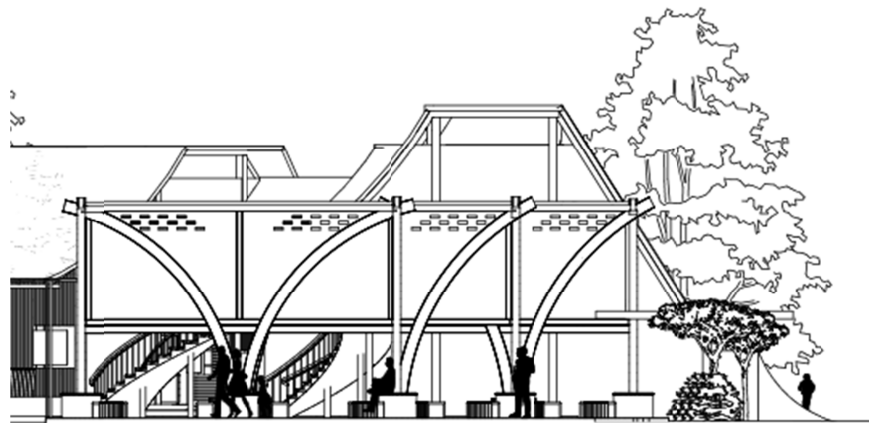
Tampak Selatan Massa Bangunan Pertama
